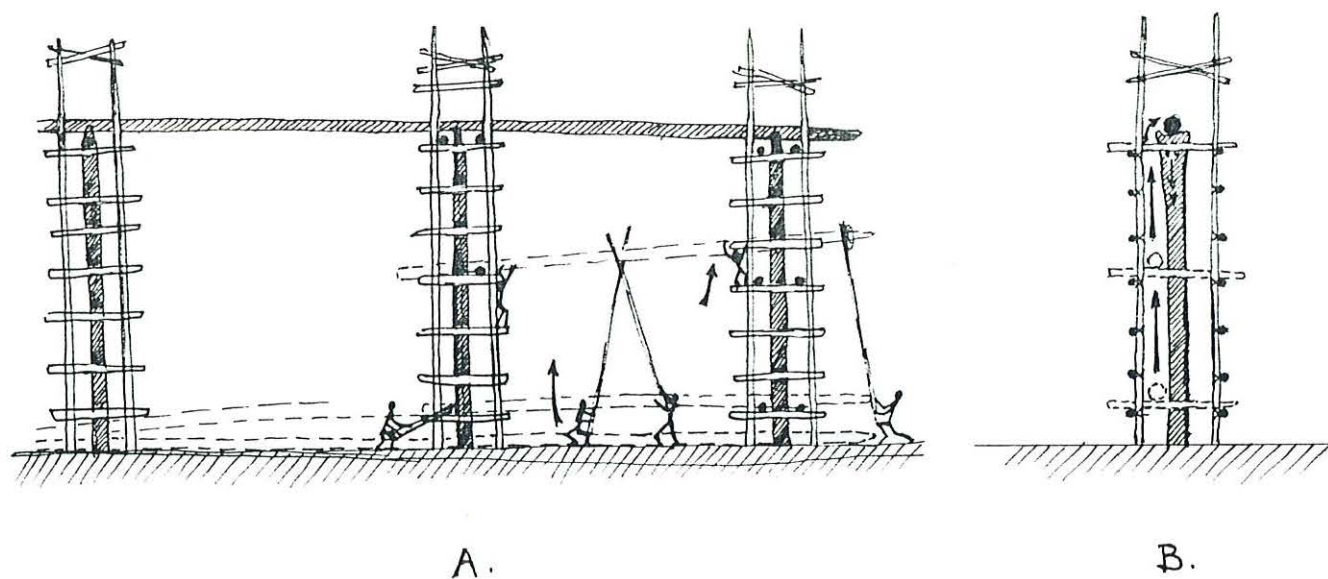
(A & B) - Technique de pose des poutres faitières. Elévation (A).
